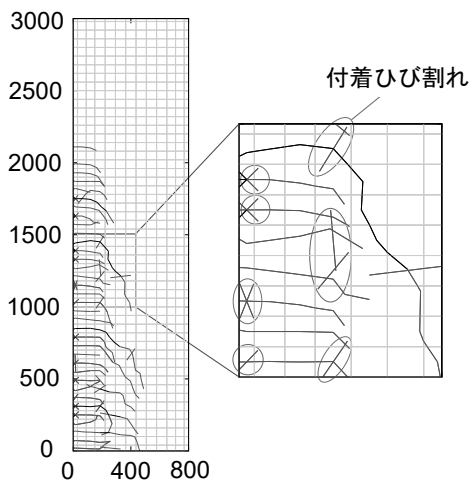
コンクリート・鉄筋間を完全固定とした場合のひび割れ性状(Unit:mm)
